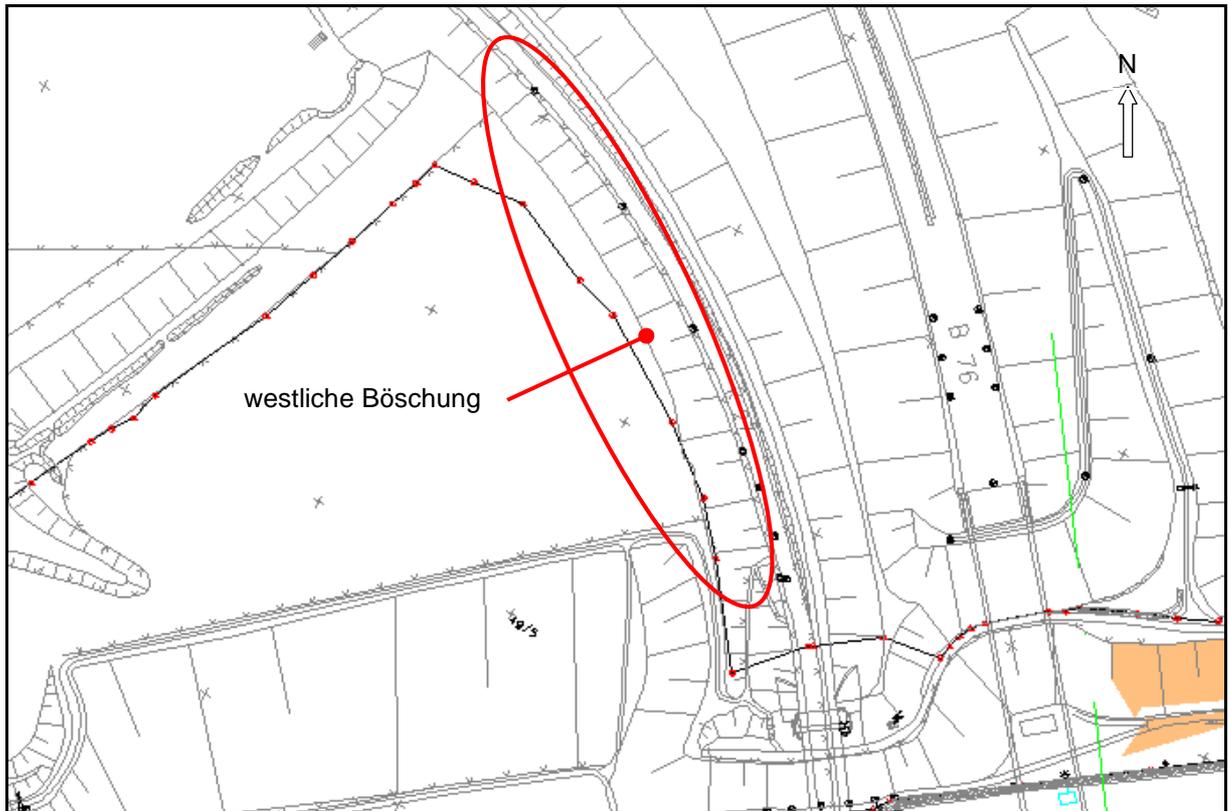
Übersichtsbild des Rampenbauwerkes "Nord" mit der westlichen Böschung
